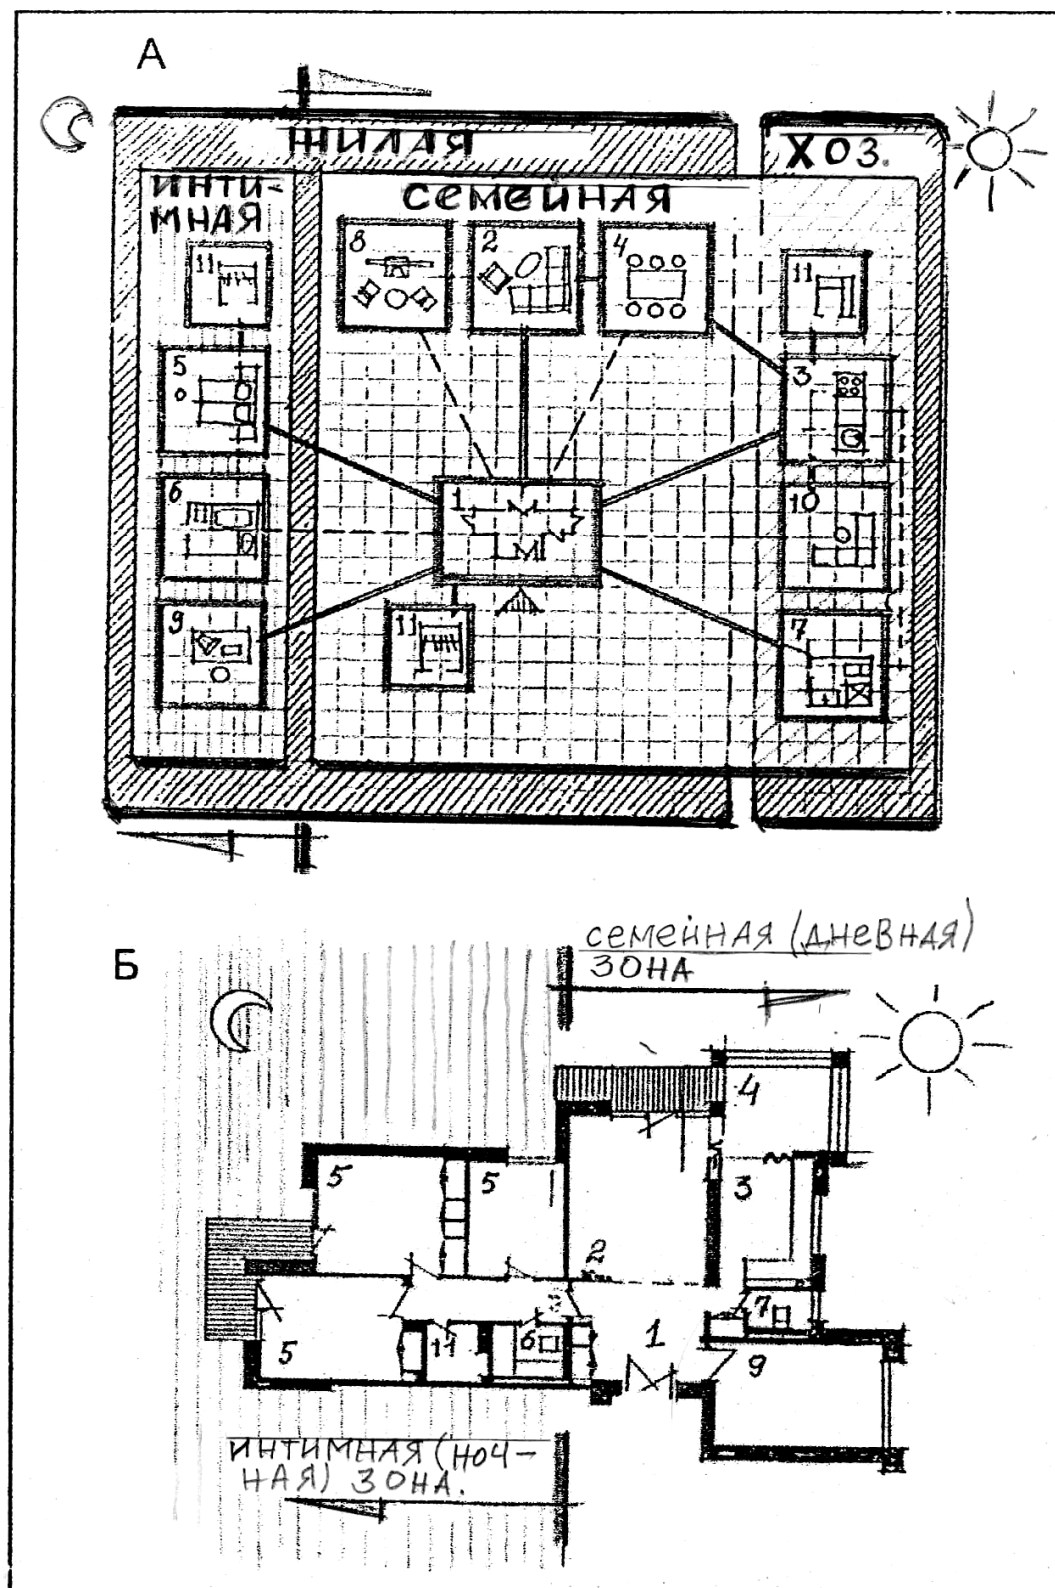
Функциональное зонирование жилища. А – схема; Б – план.
